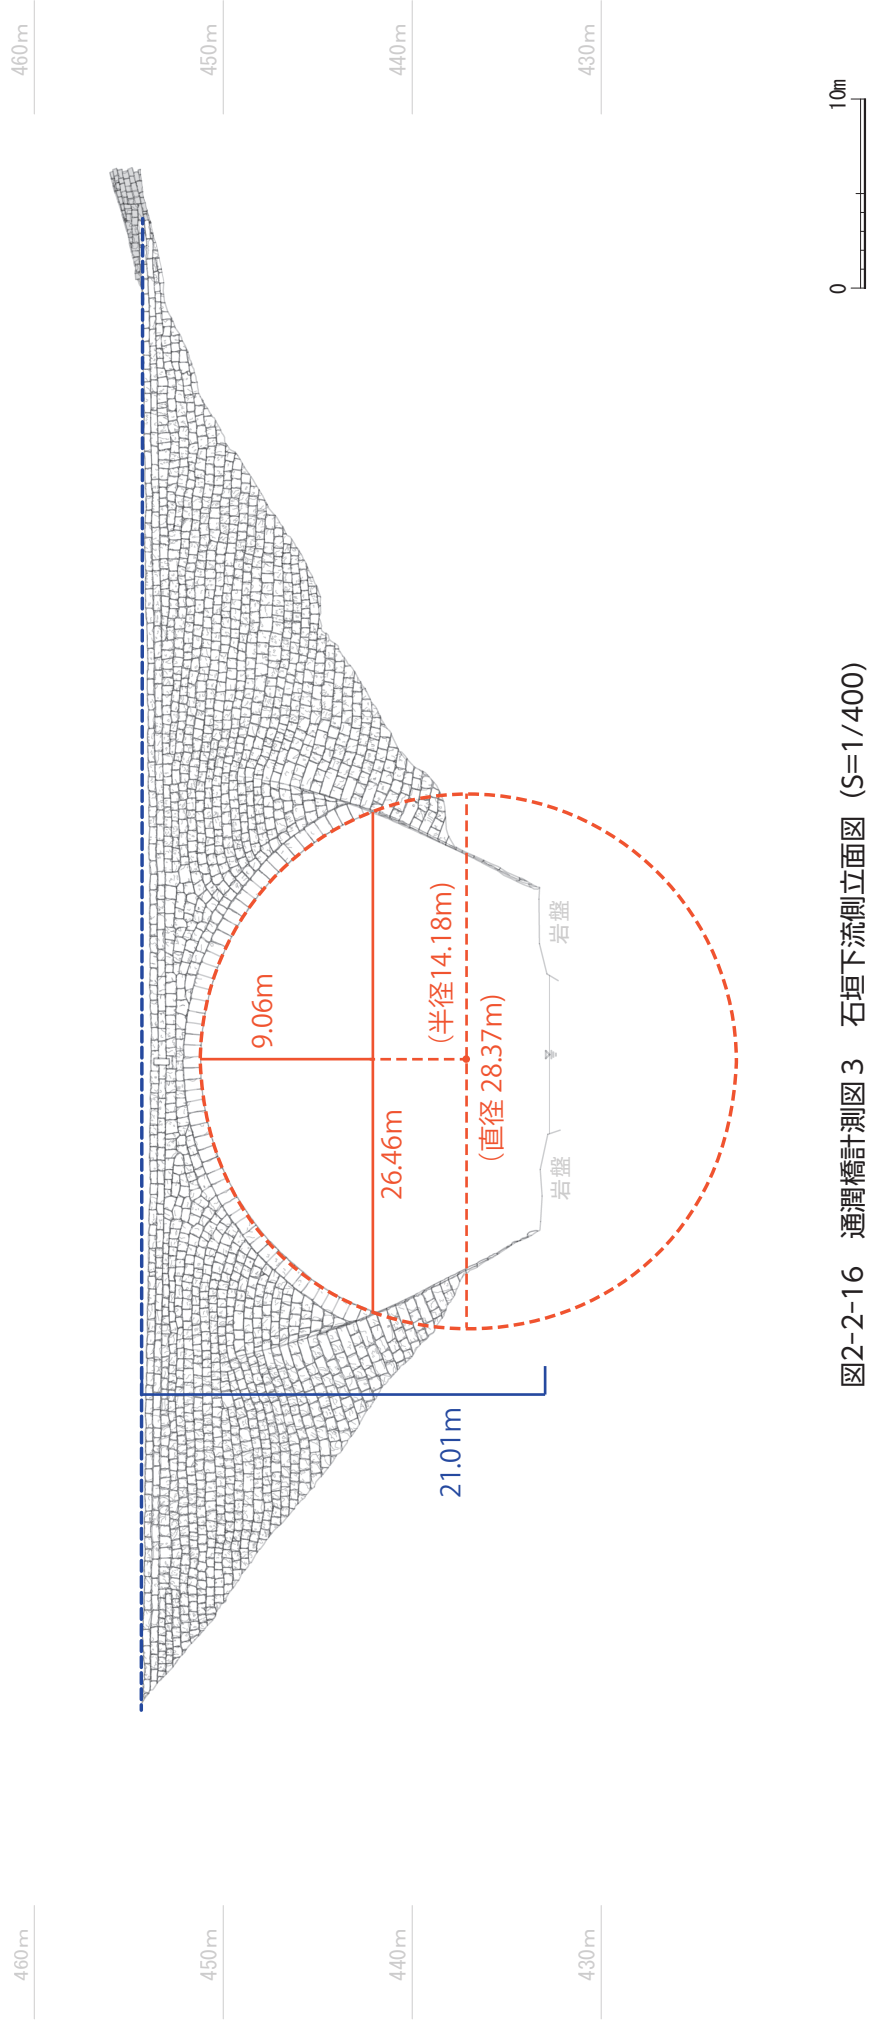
通潤橋計測図3 石垣下流側立面図 (S=1/400)
